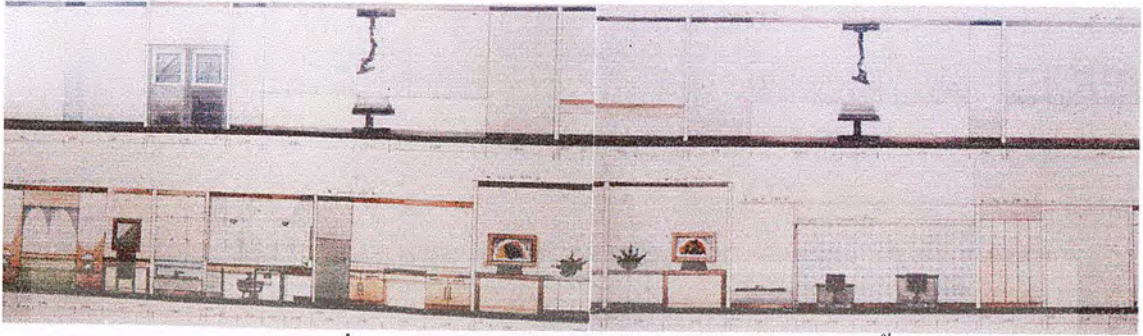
แสดงการจัด PLAN FURNITURE ชั้นที่ 2
